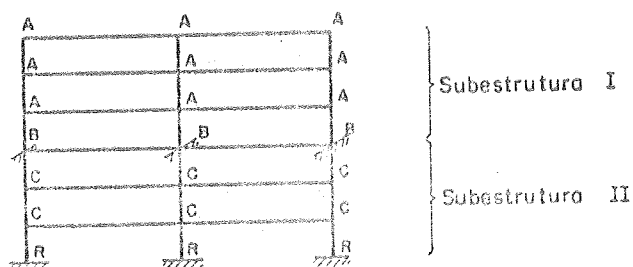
PÓRTICO PLANO DIVIDIDO EM 2 SUBESTRUTURAS
